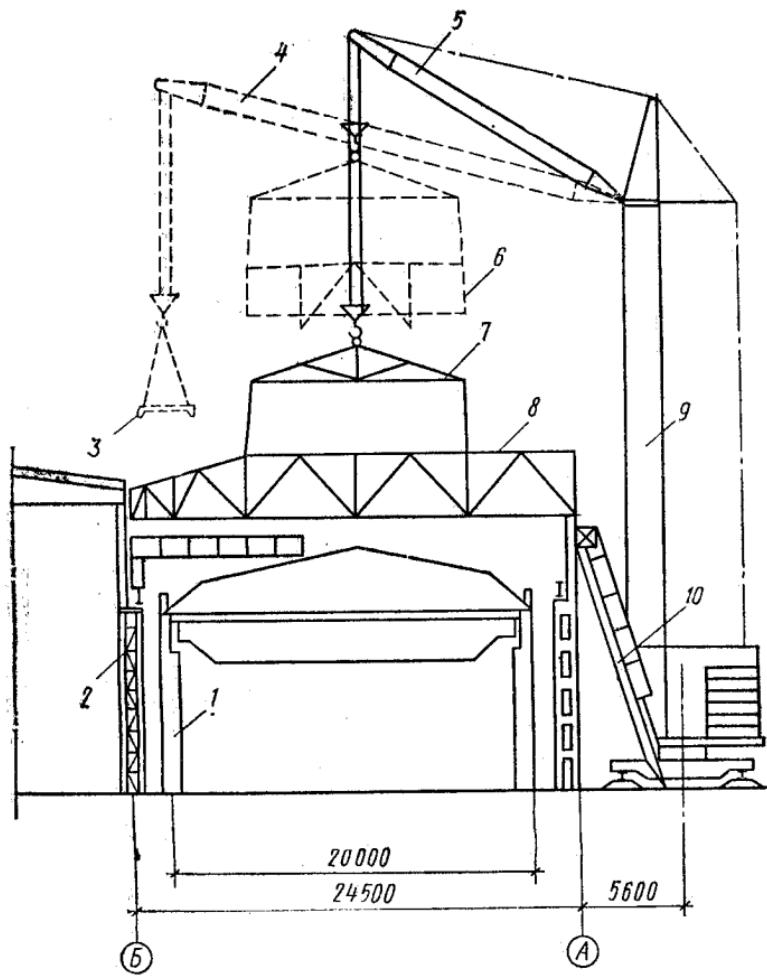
Реконструкция цеха Харьковского тракторного завода методом объемлющего каркаса:
